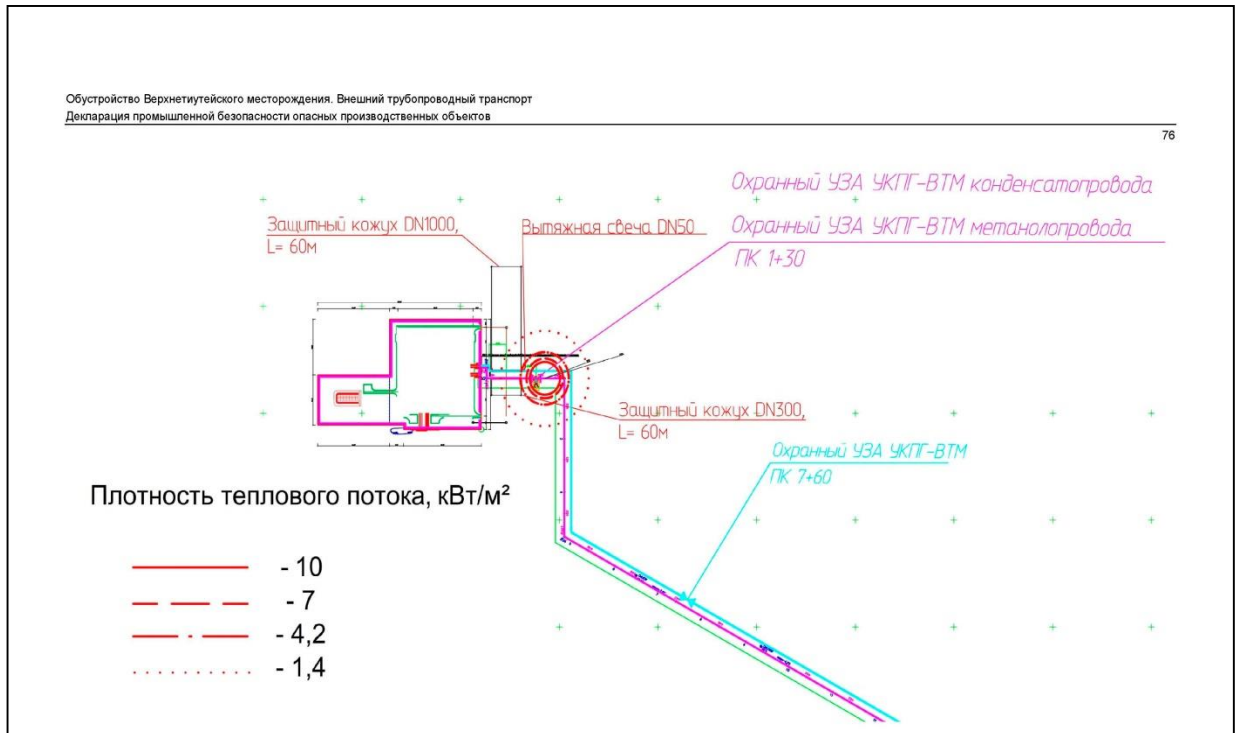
План наиболее вероятной аварии на газопроводе в районе ВТМ
